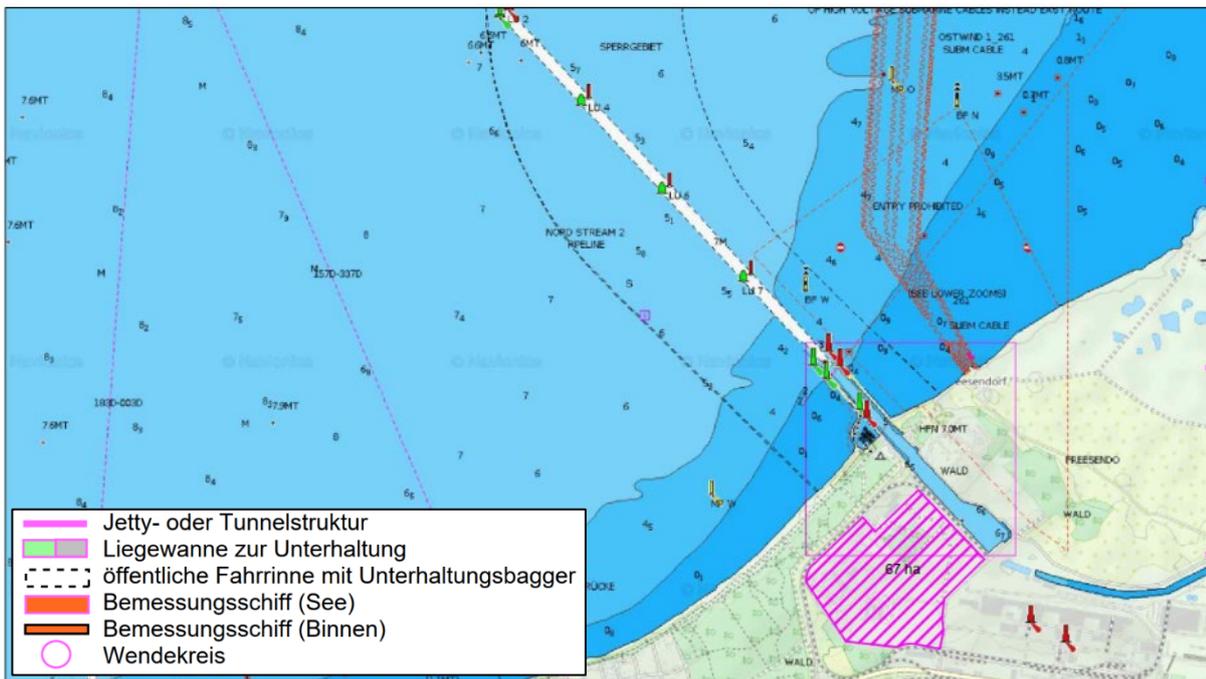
Lageplan Alternative 16: Lubmin²⁰²
